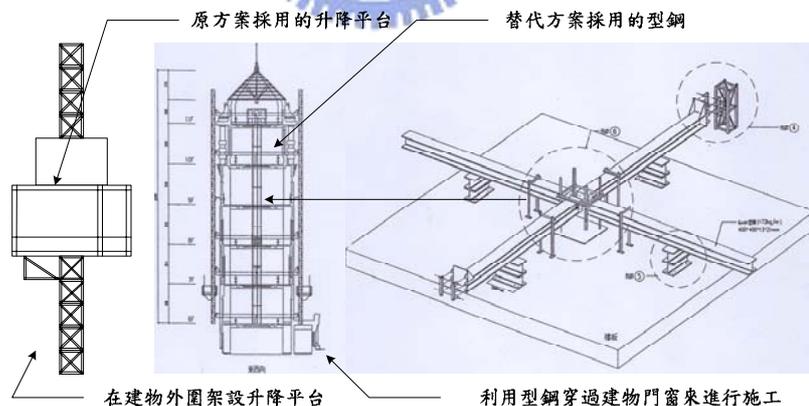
塔樓立柱型可升降式施工平台與型鋼施工平台示意
